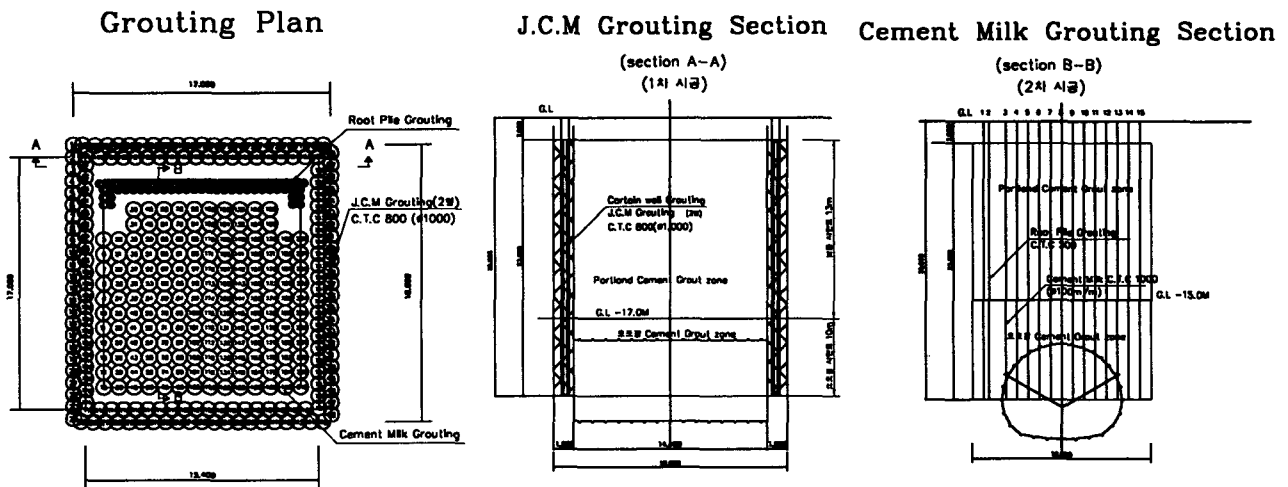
지반보강을 위한 그라우팅 평면도 및 단면도
